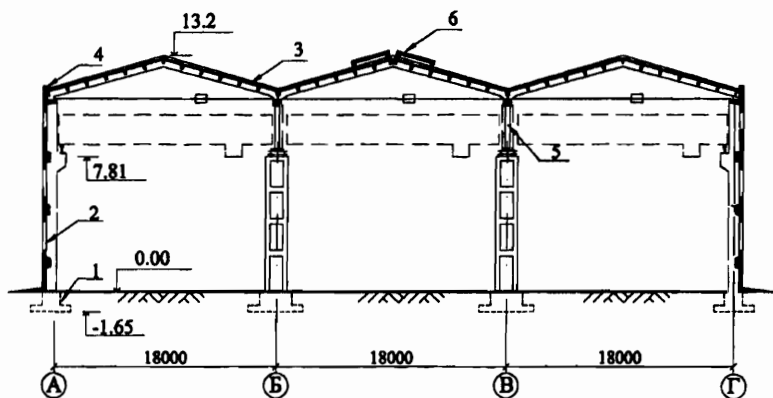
Конструктивное решение многопролетного быстромонтируемого здания: 1 - фундамент под стены и колонны; 2 - панели наружных стен; 3 - кровельная панель; 4 - фризный элемент; 5 - подкраново-подстропильная ферма; 6 - зенитный фонарь
